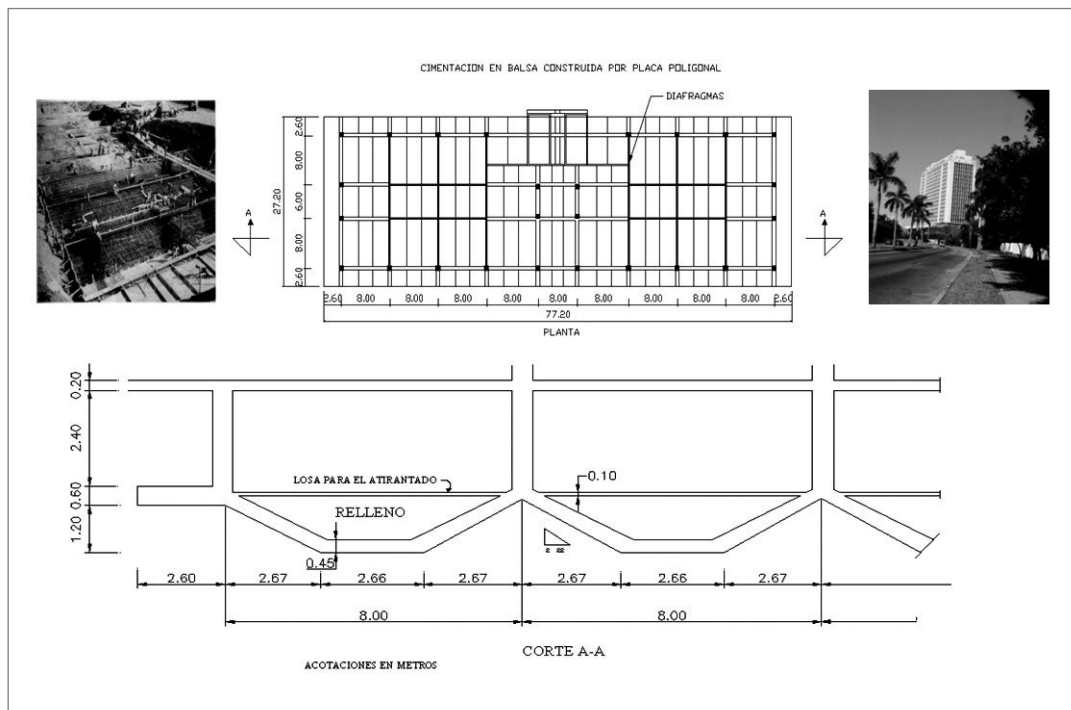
Cimentación laminar de placa poligonal (Folded Plate) para edificio alto en Ciudad de la Habana (Cortesía del Dr. Ing. Sixto Ruiz Alejo)
